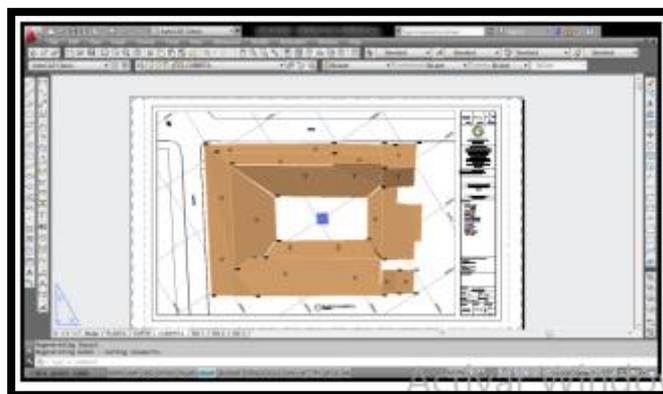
Ilustración Cubiertas en planta en AutoCAD de la biblioteca del Senado de la República de Colombia. Vista superior.
